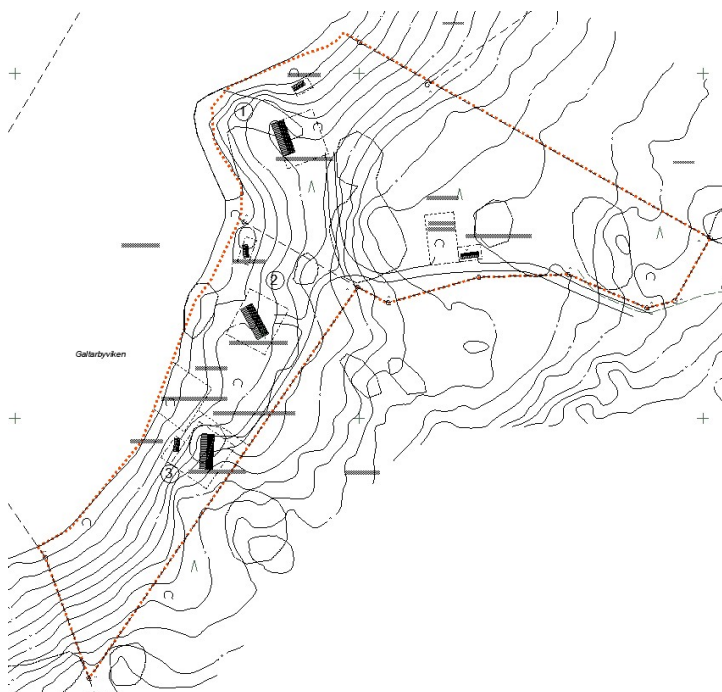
Byggnaders placering på tomten enligt den planförslaget.
